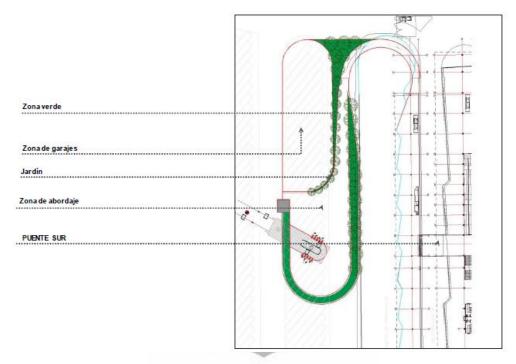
Esquema Alternativa 2 de transferencia en planta
